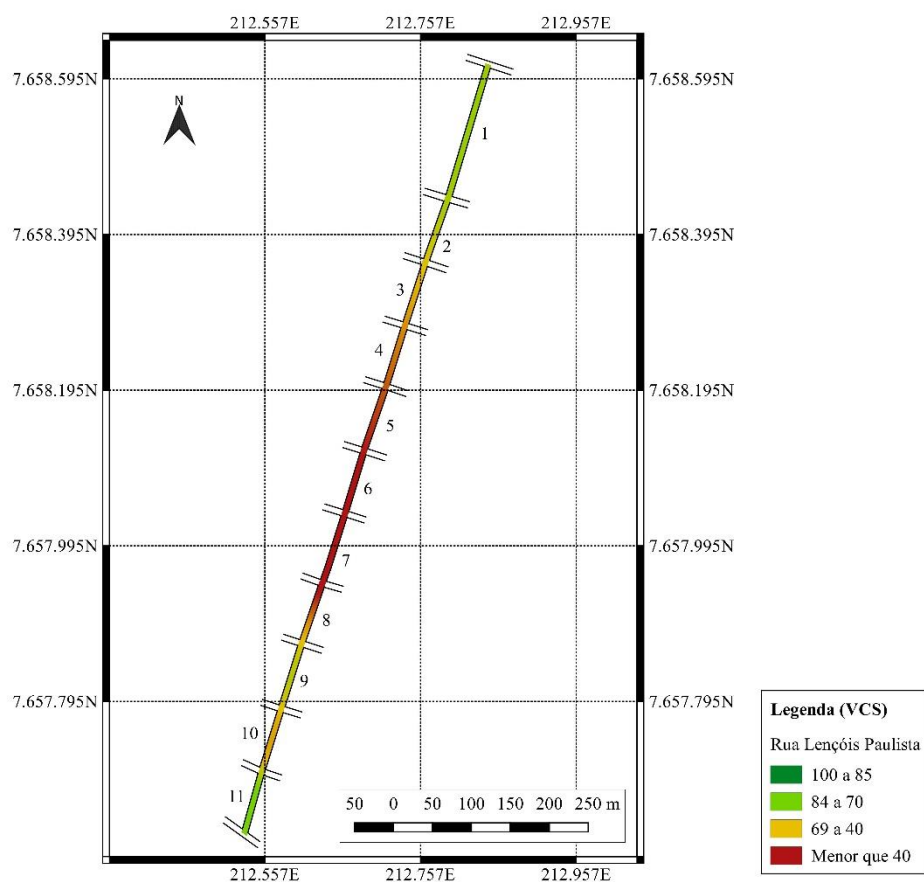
Condição superficial do pavimento na rua Lençóis Paulista
